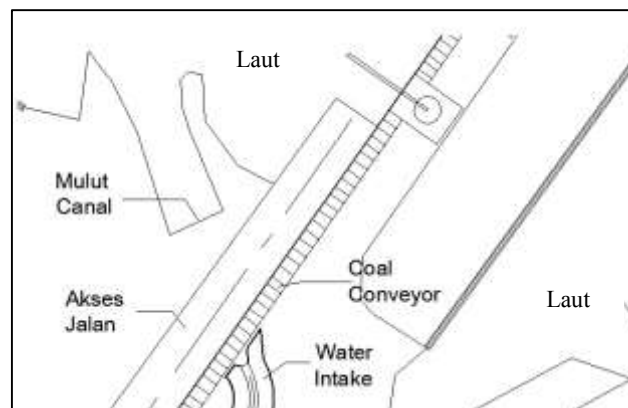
a. Layout Area Keruk Kolam *Canal Water Intake
